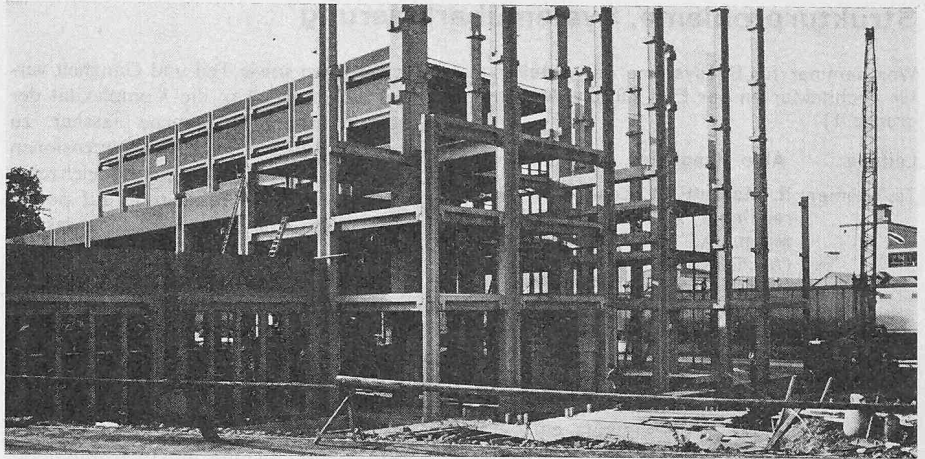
(l.). Konstruktives Gerippe, in welches beliebige Fassadenelemente eingebaut werden können
